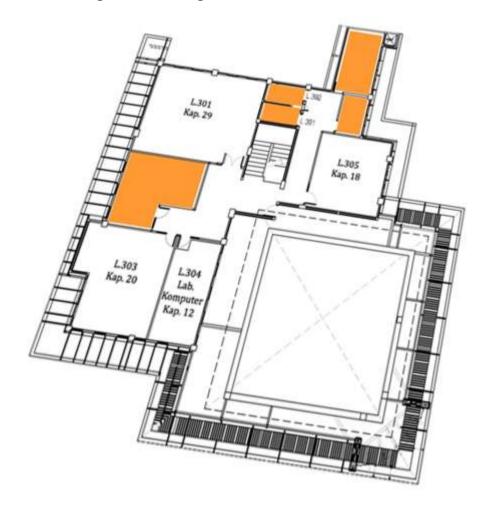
Denah Ruang Kuliah Gedung K Lantai 3
